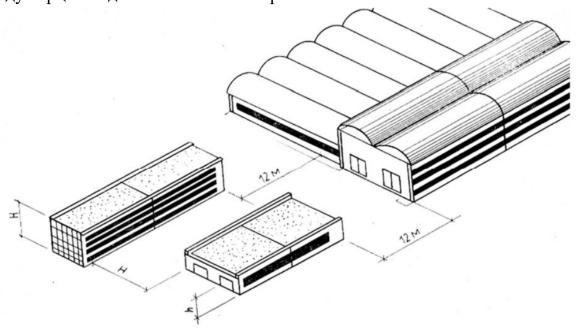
Санитарные разрывы между зданиями, освещаемыми через проемы
